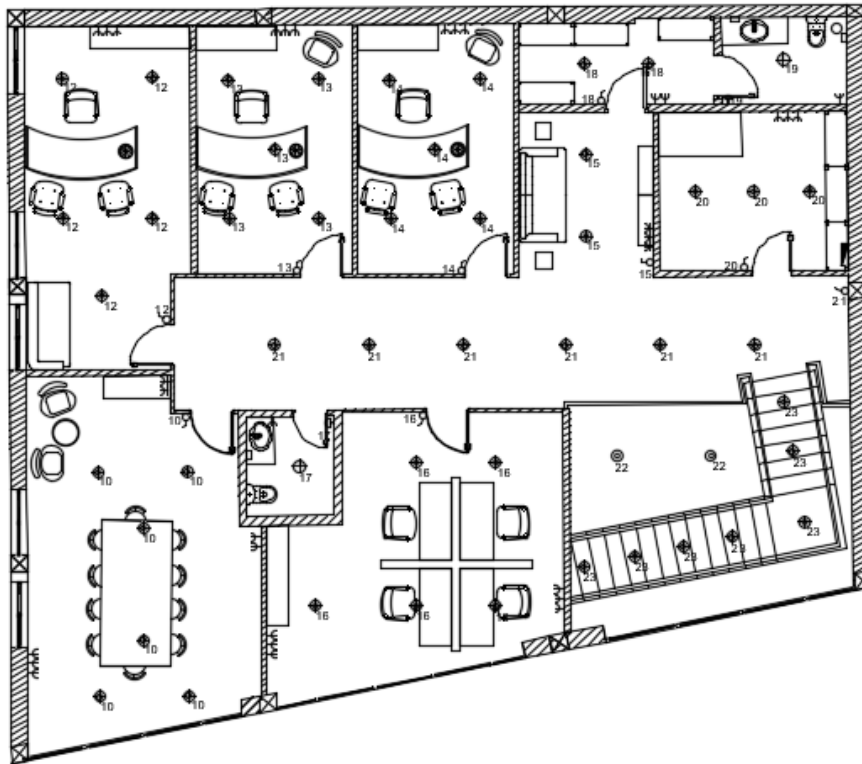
Planta de iluminação, piso 1. Fonte: Ana Cândido.
